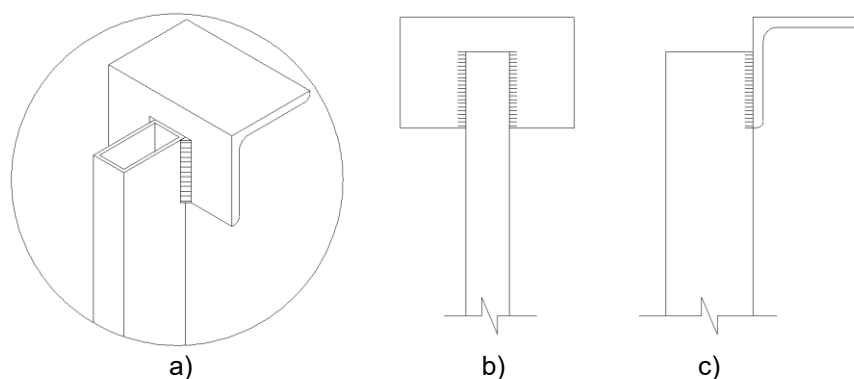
Vistas de la unión por soldadura: a) isométrico b) frontal c) lateral
